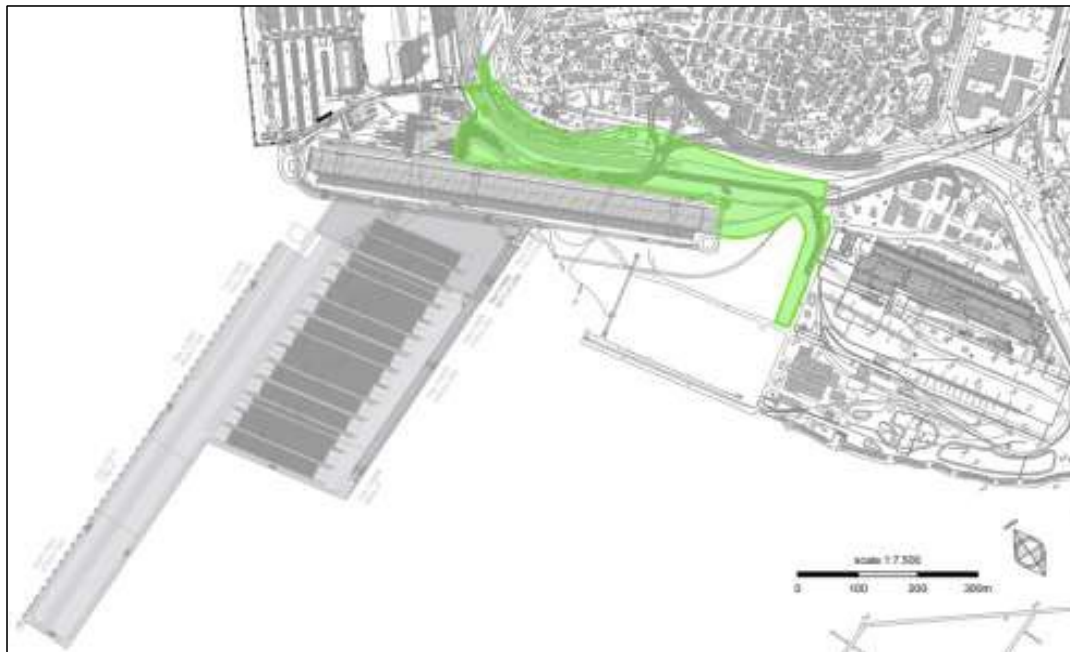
Individuazione su planimetria delle opere di messa in sicurezza permanente
